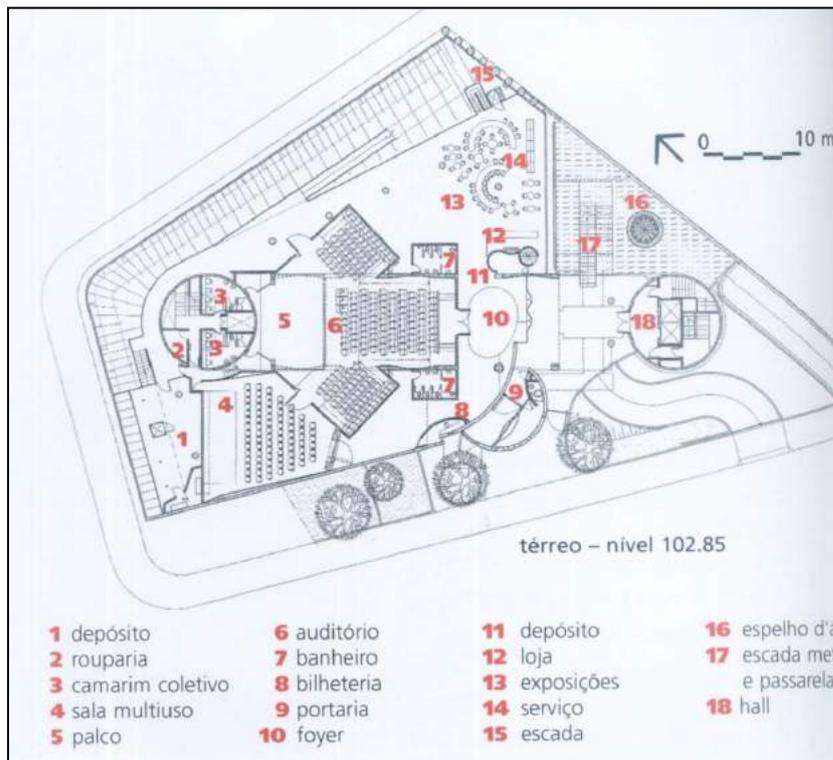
Planta Térreo – Centro da Cultura Judaica
